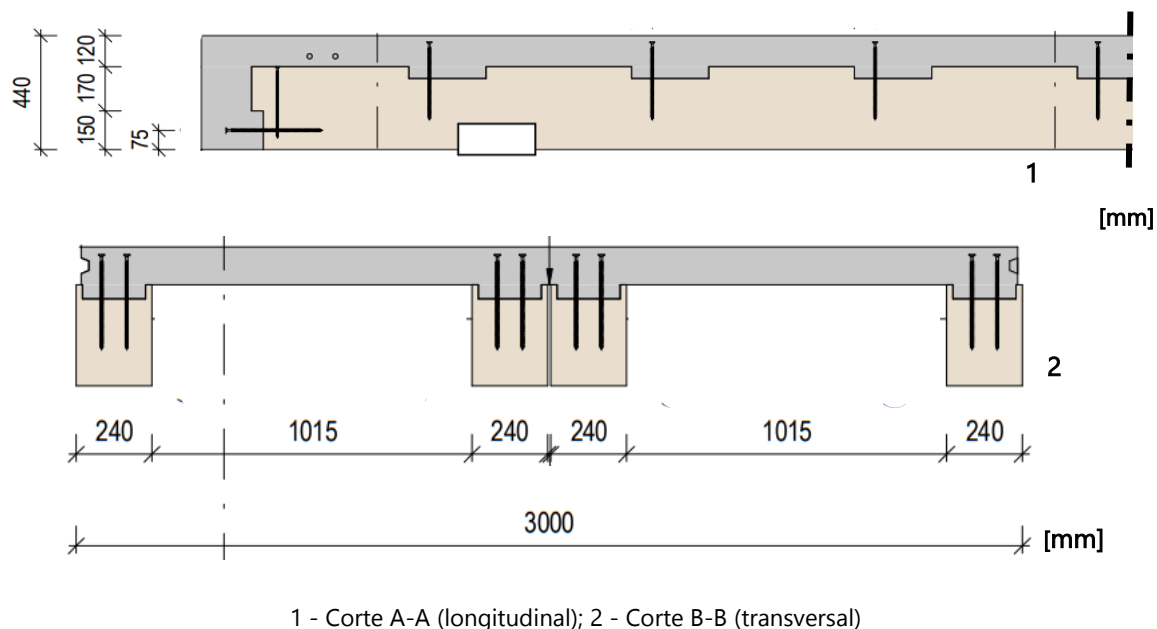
Cortes A e B da laje mista com 4 vigas de madeira (sem escala)
